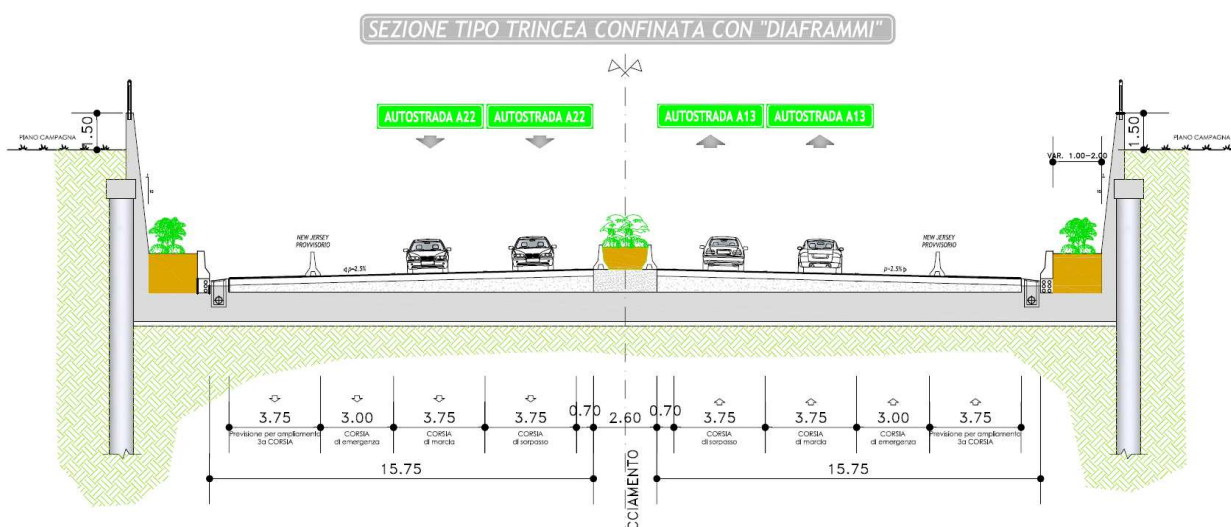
SEZIONE TIPO IN TRINCEA CONFINATA CON DIAFRAMMI
